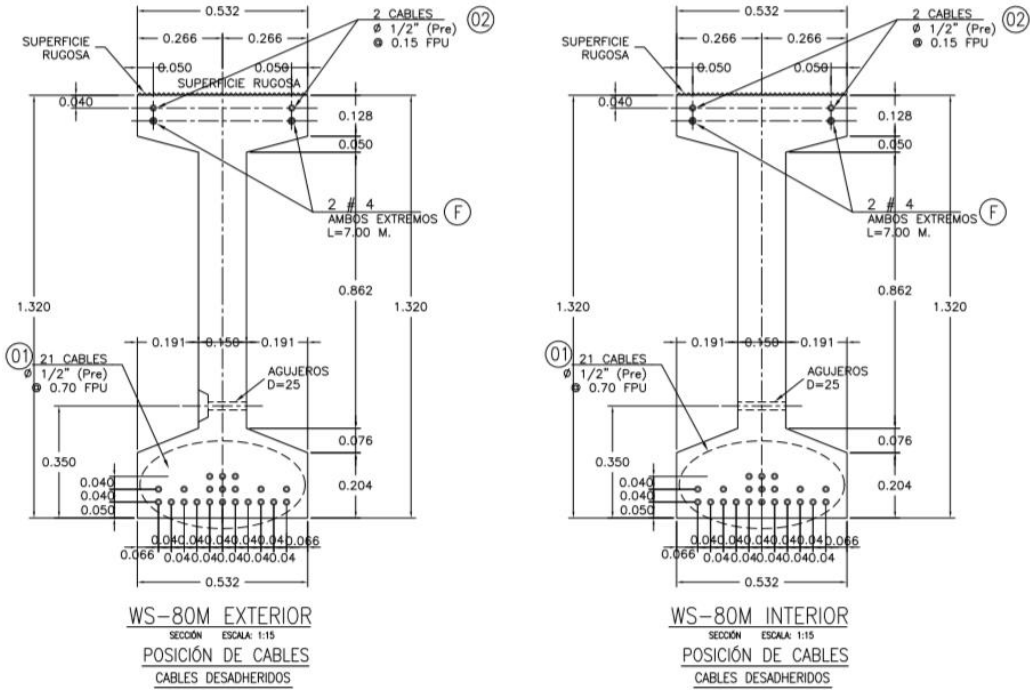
Detalles de Cables de Pretensado Viga WS-80, Claro= 20 mts
